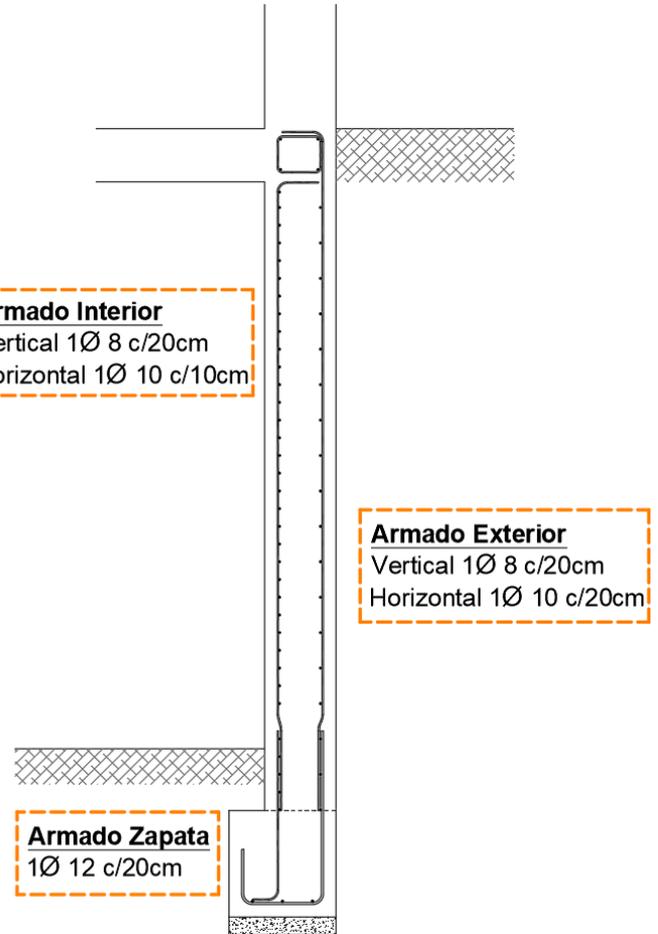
Detalle del muro de contención de tierras con se respectivo armado.
